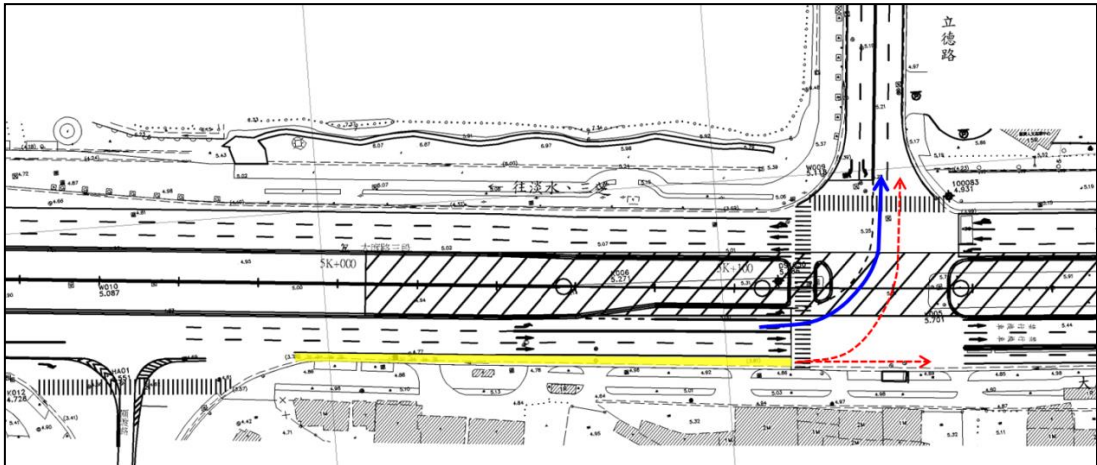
大度路局部車道配置及立德路路口優化平面圖
